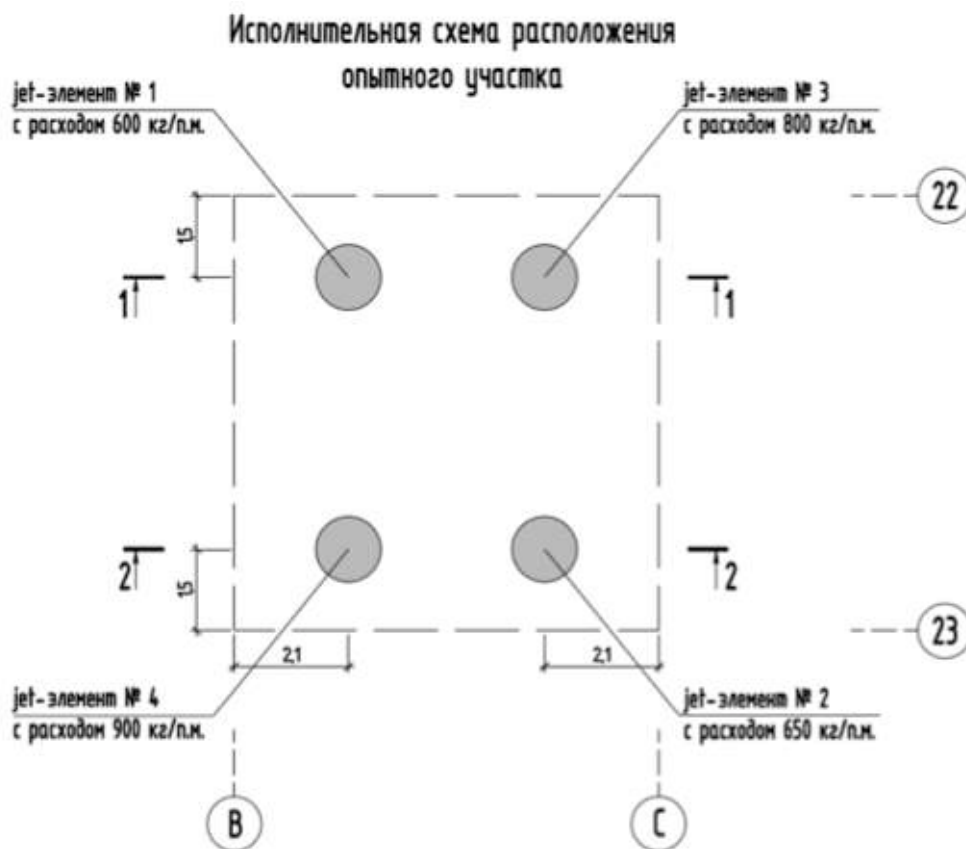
Схема выполнения грунтоцементных элементов на опытном участке
